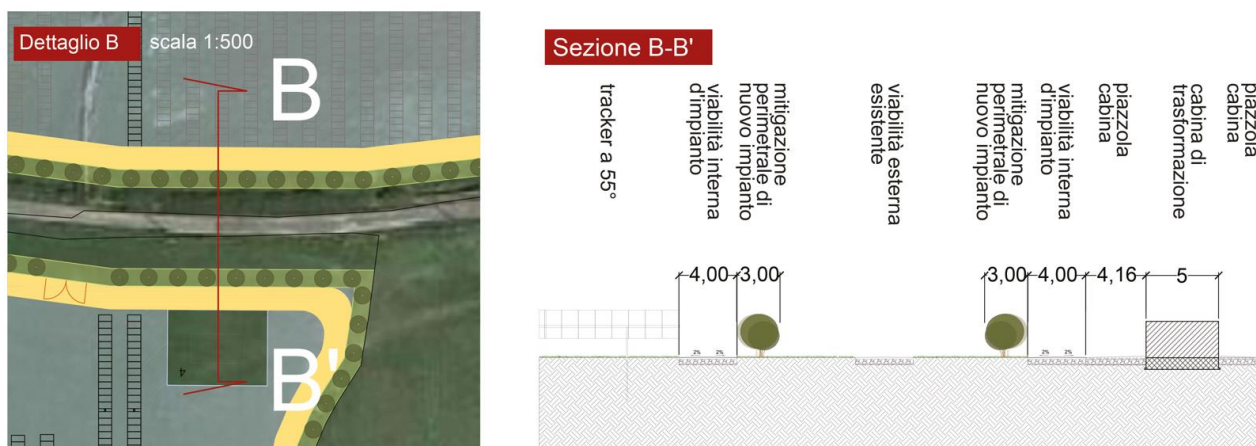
PARTICOLARE FASCIA DI MITIGAZIONE E CABINA DI TRASFORMAZIONE – SEZIONE N-S DELL'IMPIANTO – ESTRATTO DALL'ELABORATO GRAFICO SIL-PDT11)
